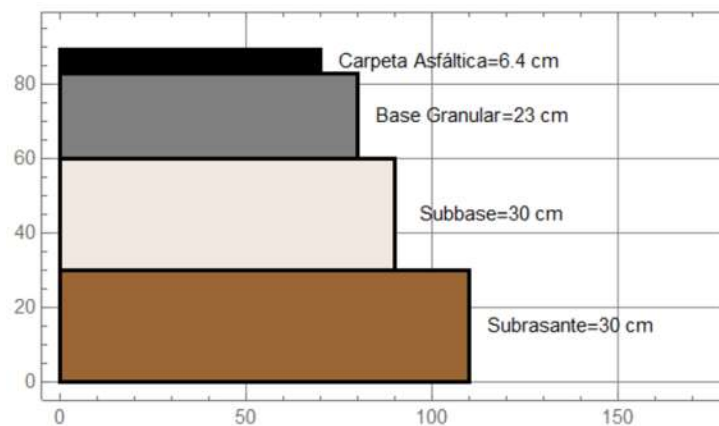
Estructura de Pavimento Flexible del Tramo Analizado.
